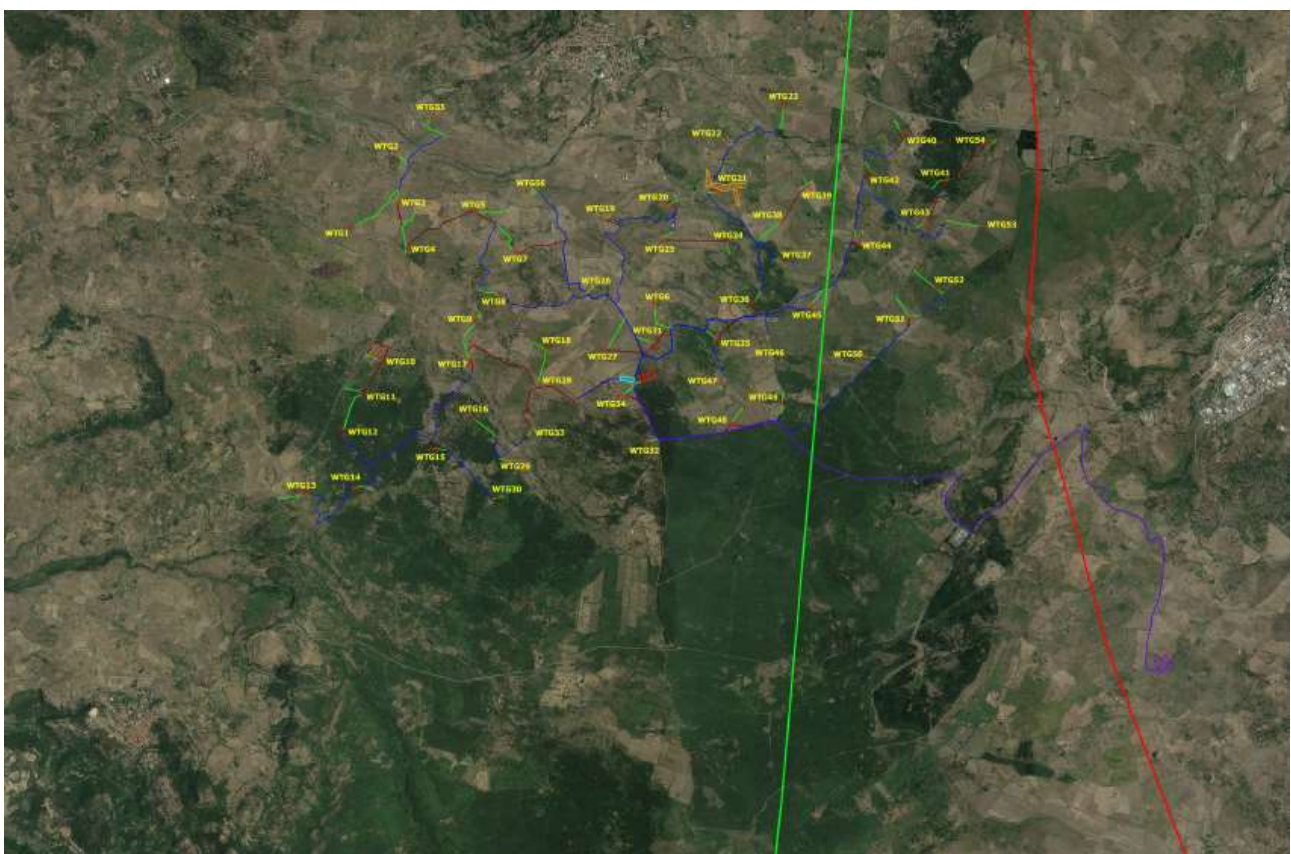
\_Estratto della Tav.03 Layout impianto su ortofoto
